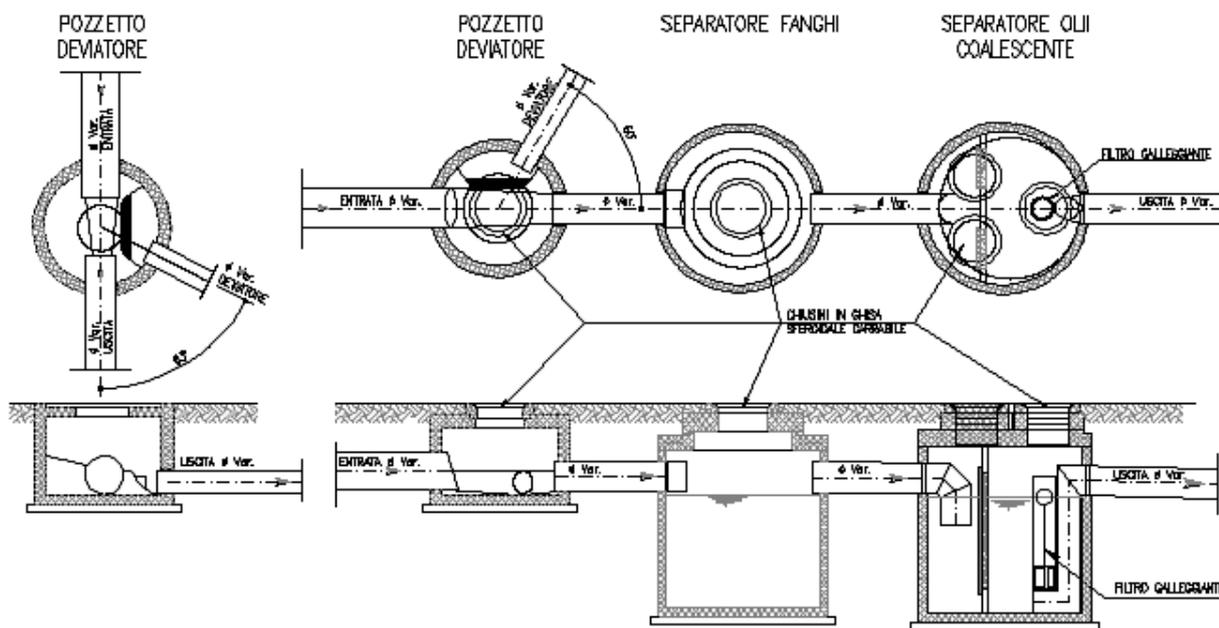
Pianta e sezione dell'impianto di trattamento di prima pioggia con by-pass
